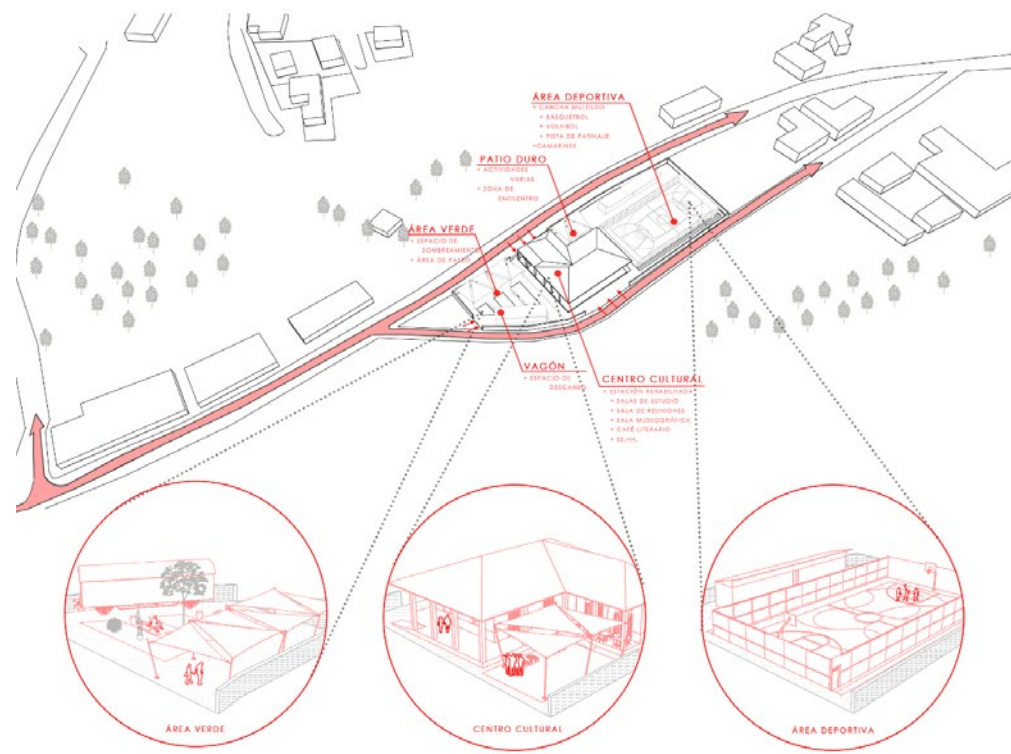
| Plan Maestro. Fuente: elaboración propia.
